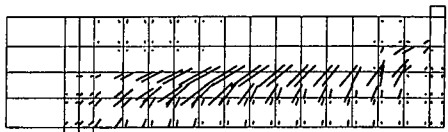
No.1 のひび割れ状況 (回転ひび割れモデル)
